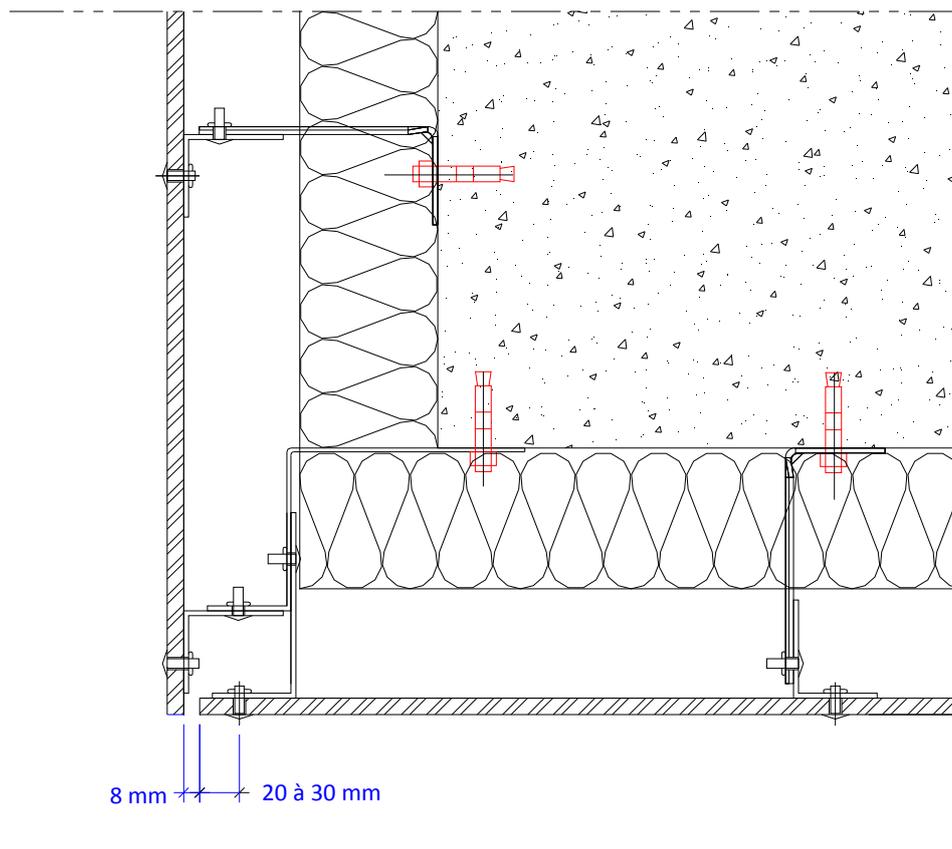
Coupe sur tableau de baie – Ossature métallique
